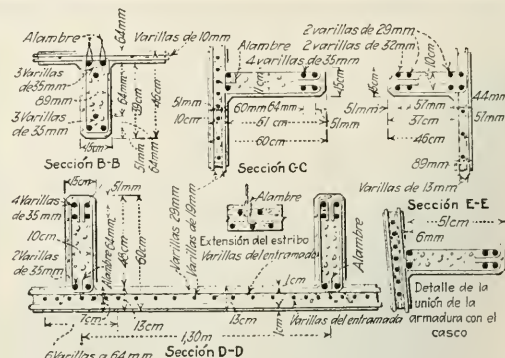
DETALLES DEL CASCO Y DE LAS LOSAS DE CUBIERTA
